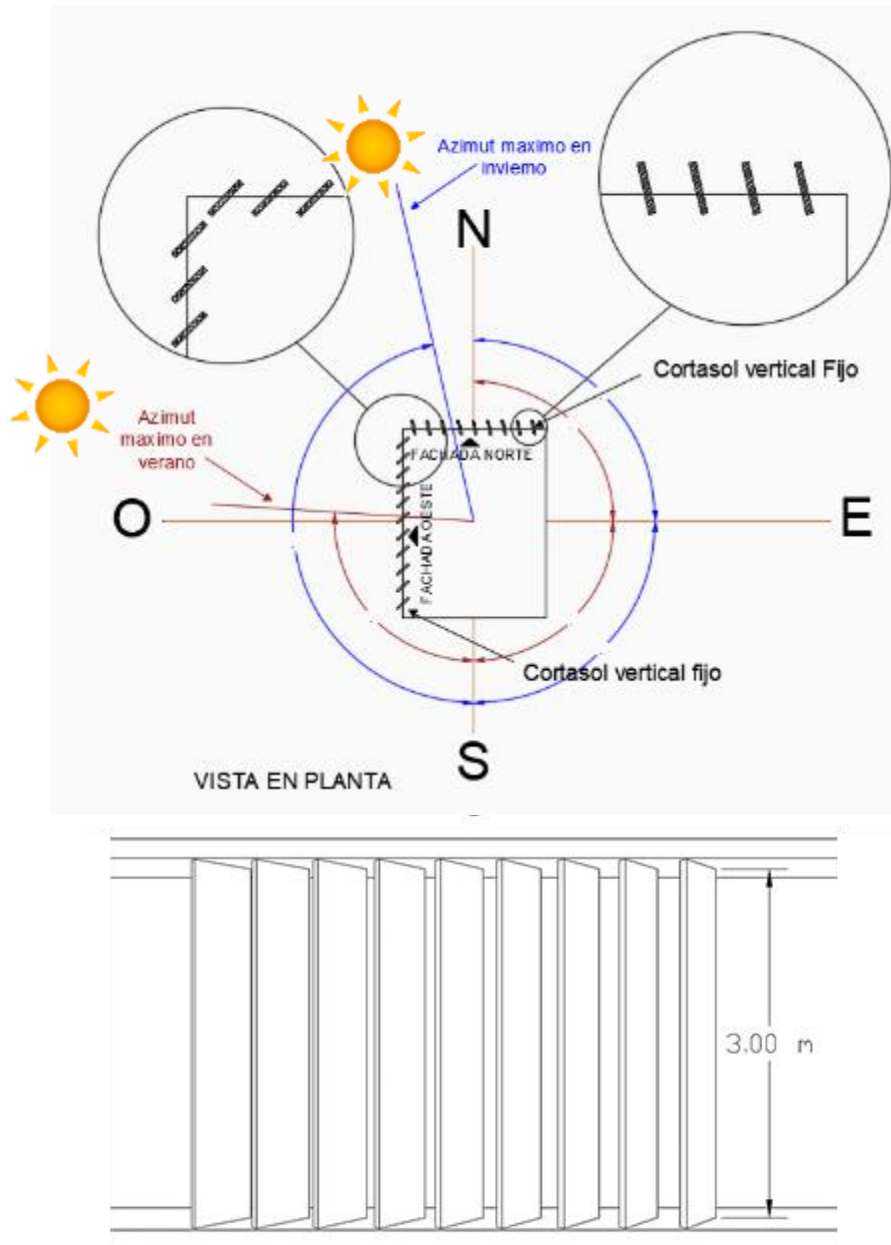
Detalle de cortasoles verticales fijos. Fuente: Elaboración propia
